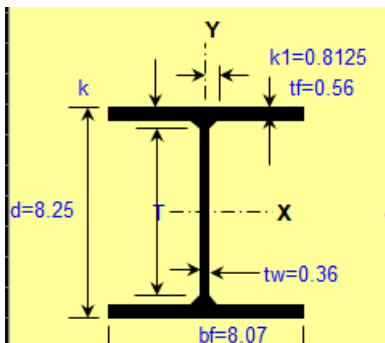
Acero Estructural, sección de columna CM-1 (W 8x40)
